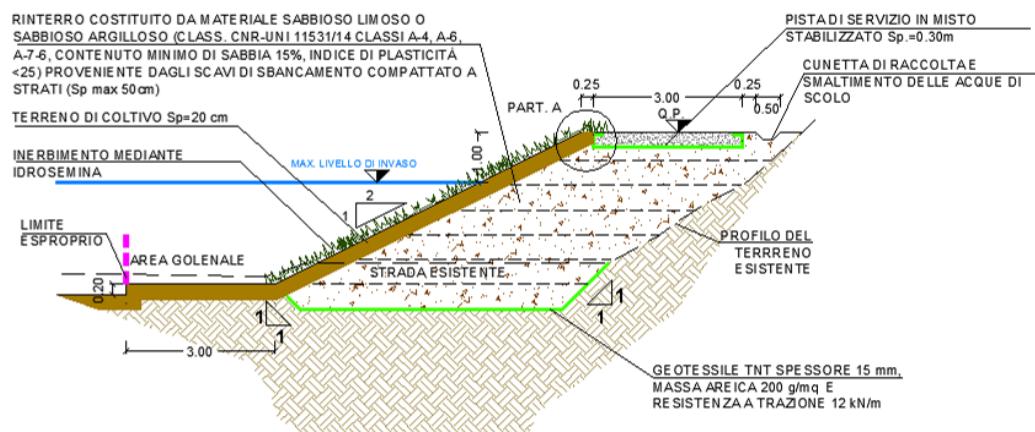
Sezione tipo di rialzo della viabilità esistente
